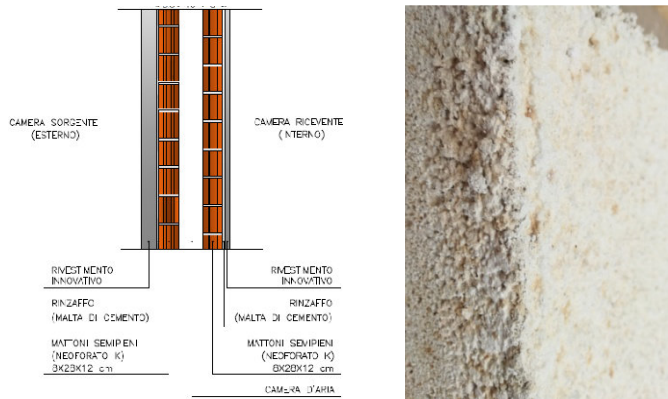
Campione in prova: sezione del muro di base con applicati gli intonaci e particolare dell’intonacoinnovativo da 6 cm.
